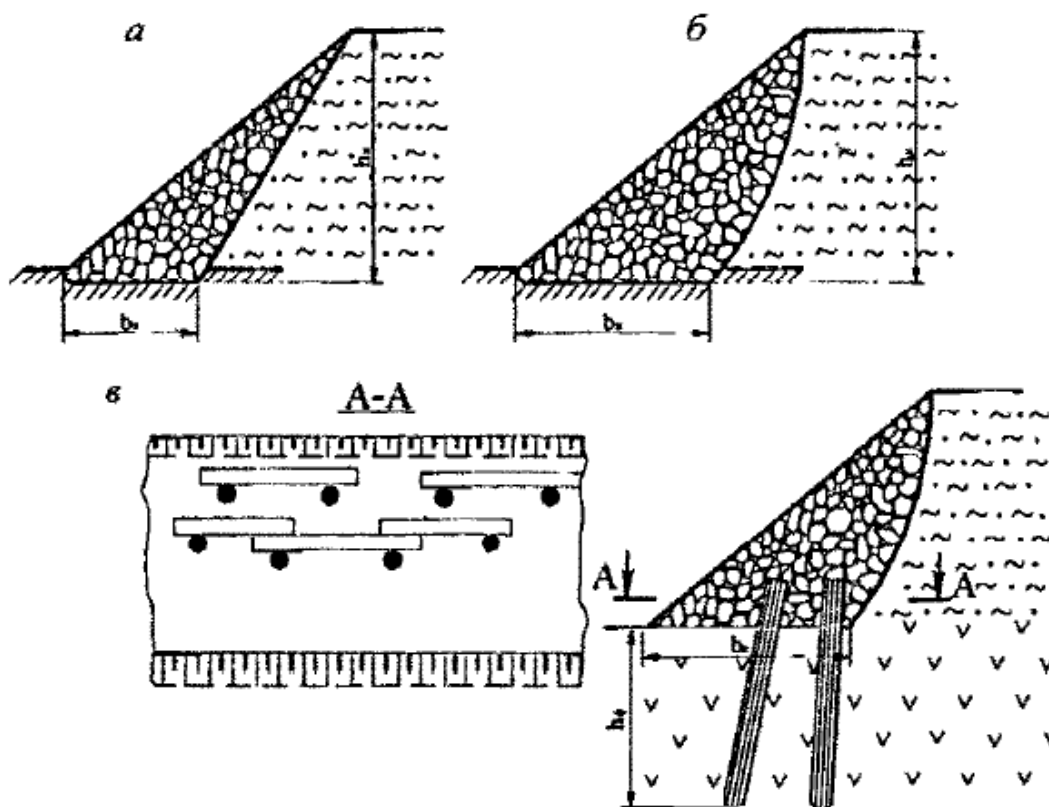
Схемы возведения контрфорсов из скальных пород: а и б – отсыпаемые на прочное скальное основание; в – отсыпаемые на свайный фундамент; h_k , b_k – высота и ширина основания контрфорса; h_ϕ – глубина забивки свай фундамента
